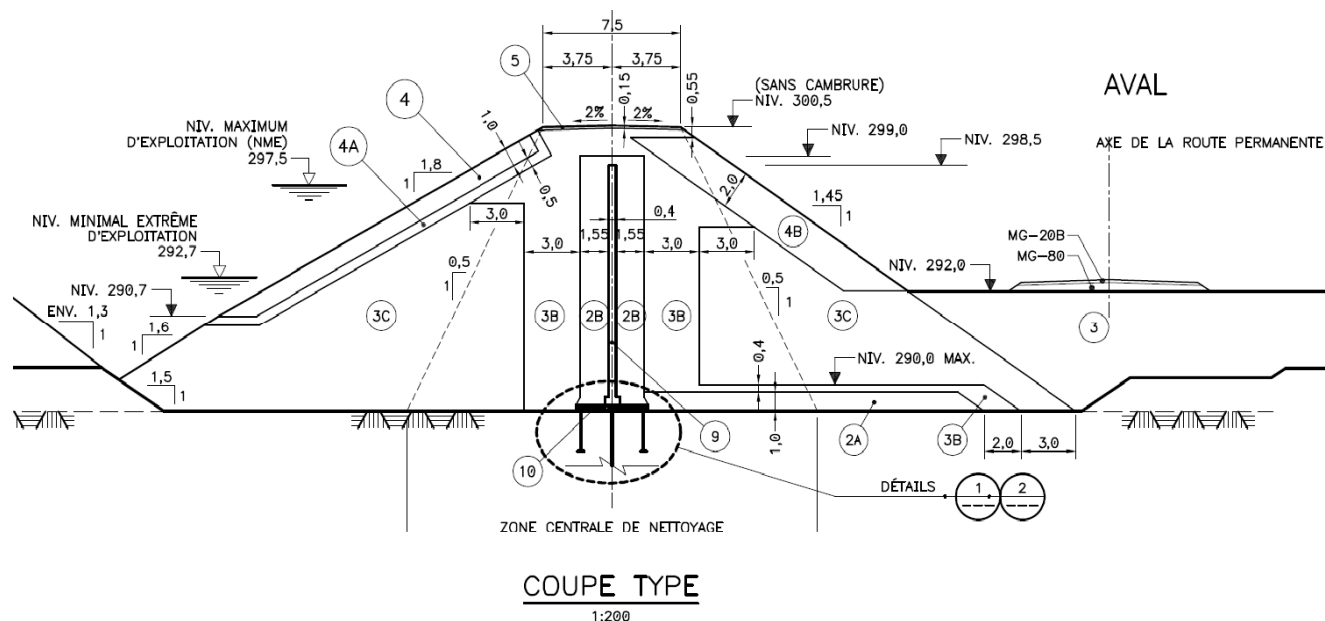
coupe transversale du barrage de Nemiscau-1 (coupe fournie par Hydro-Québec)
